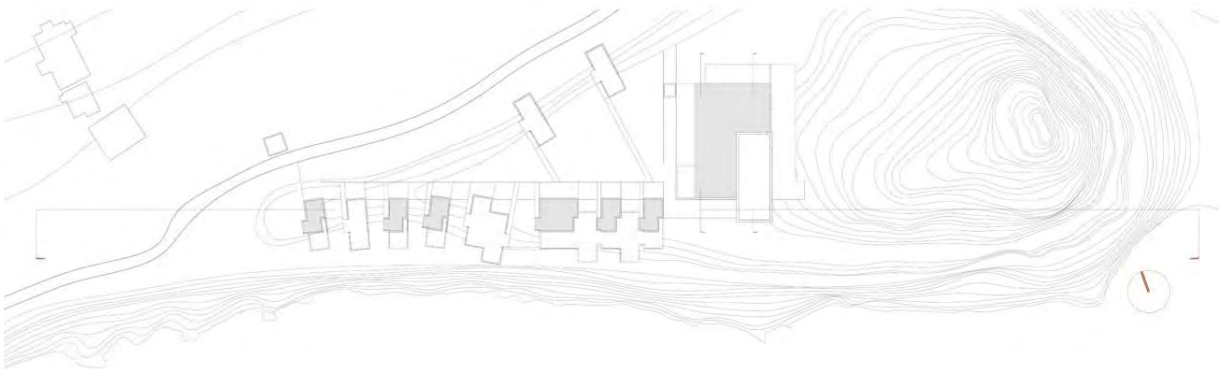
Plan d'ensemble et coupe long, étape préliminaire
